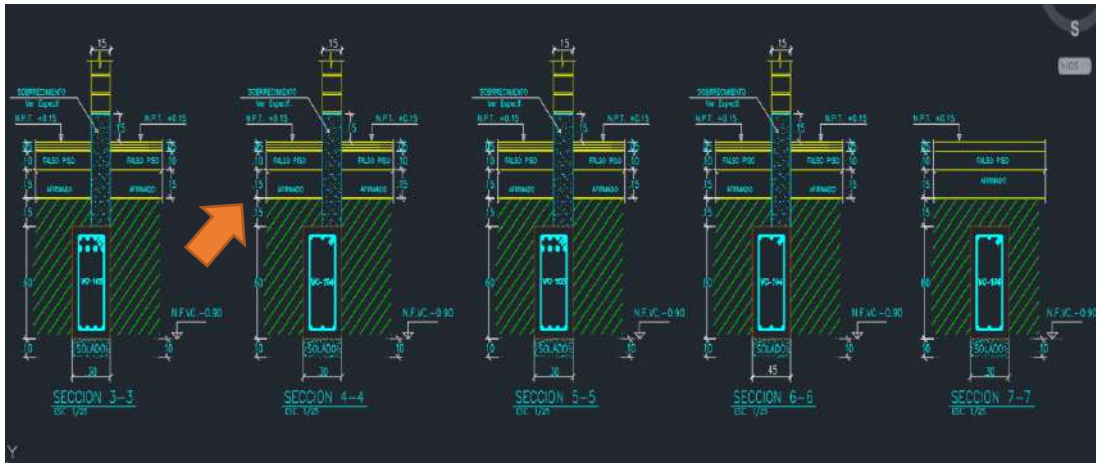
Incongruencia en Detalles estructurales de ZC – 03.
